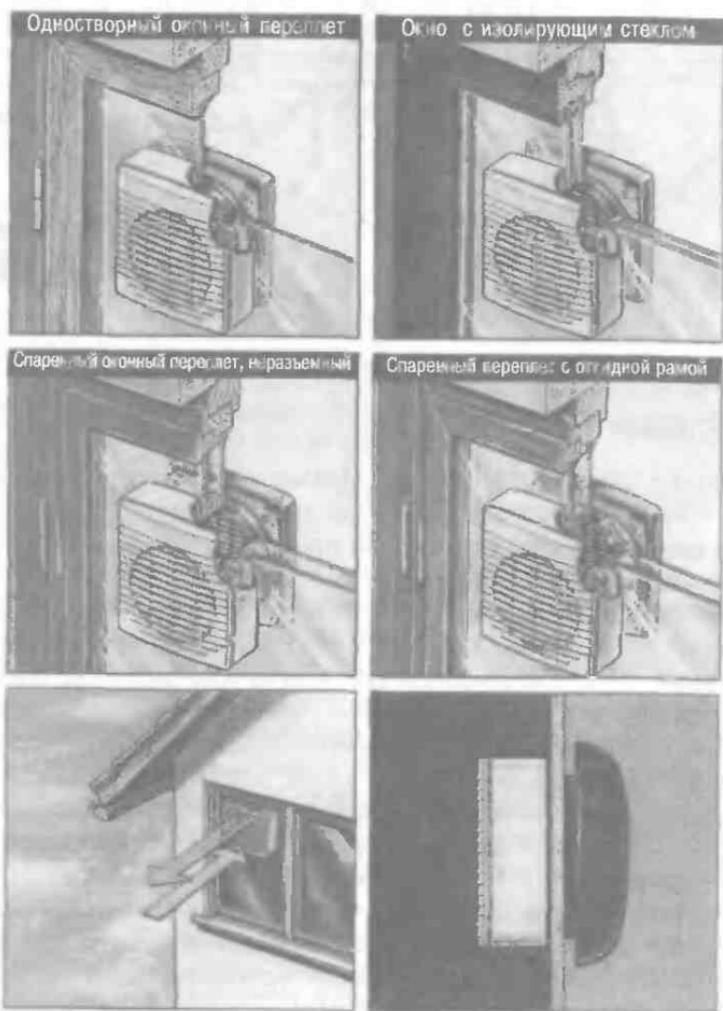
Вентиляторы Rover (EA) для монтажа на стенах и в окнах [36].
